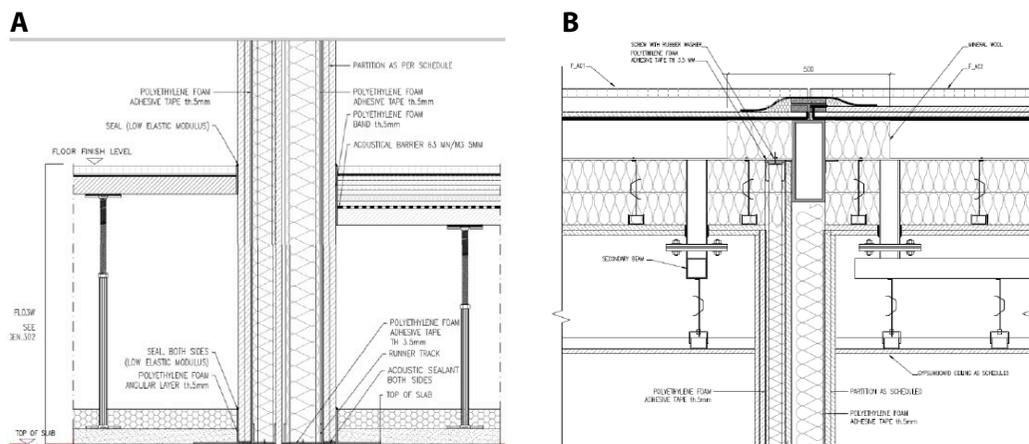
Dettagli delle giunzioni tra parete divisoria, soffitto e pavimento
